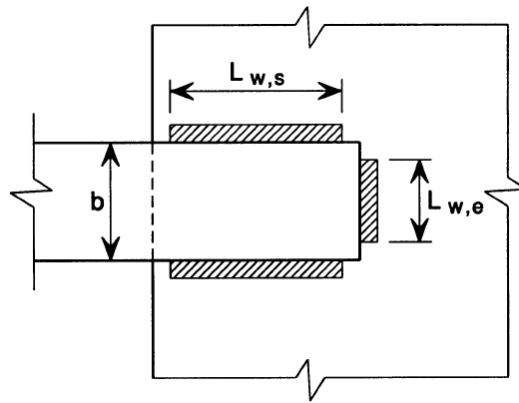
Assemblage par soudures d'angle à clin
